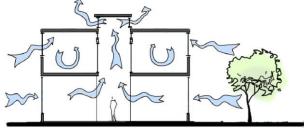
Ventilación-efecto chimenea Fuente: elaboración propia
